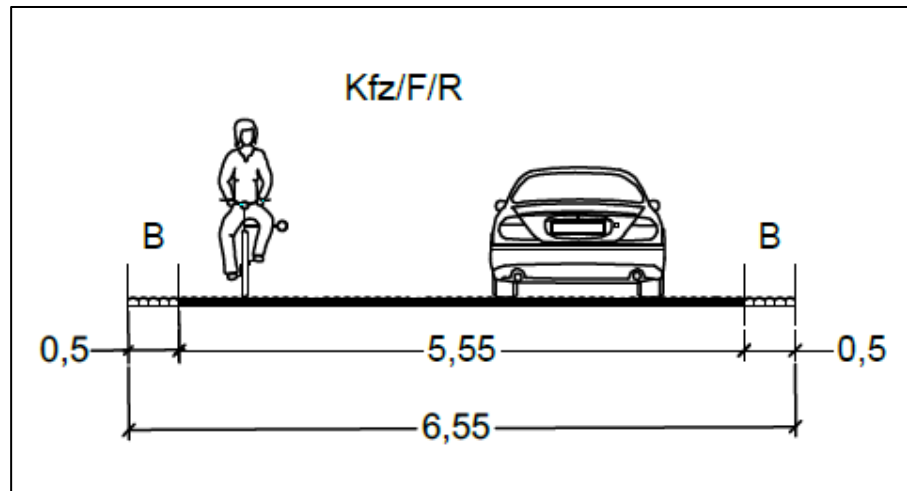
Straßenquerschnitt Planstraße B, Angaben in Meter
